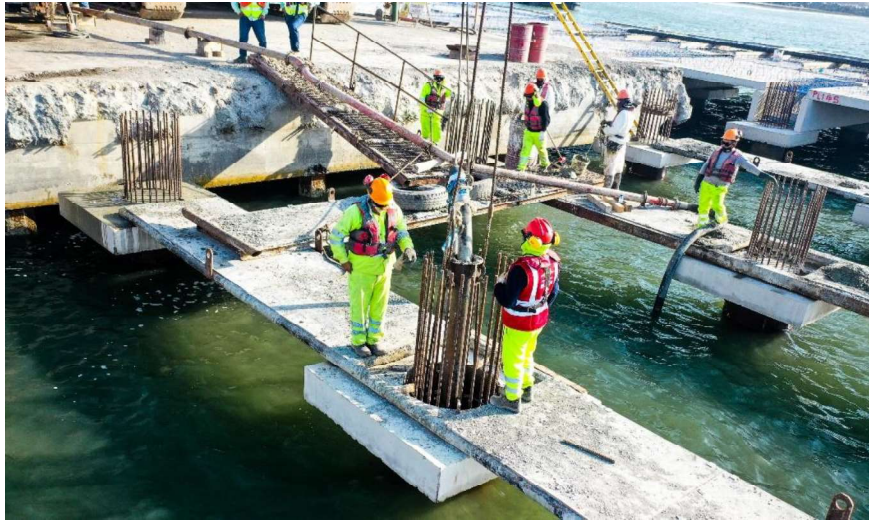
Colocación de concreto en pilotes. Consorcio CRT
